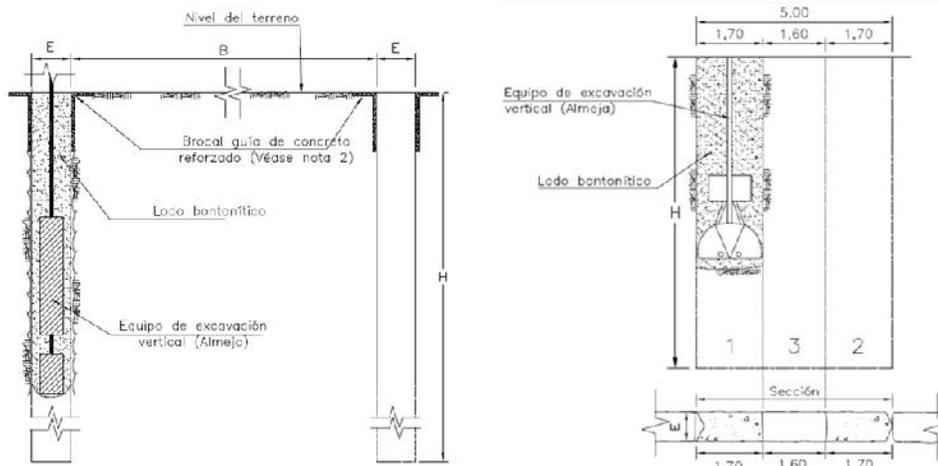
Secuencia de construcción de las pantallas preexcavadas (cortes)
